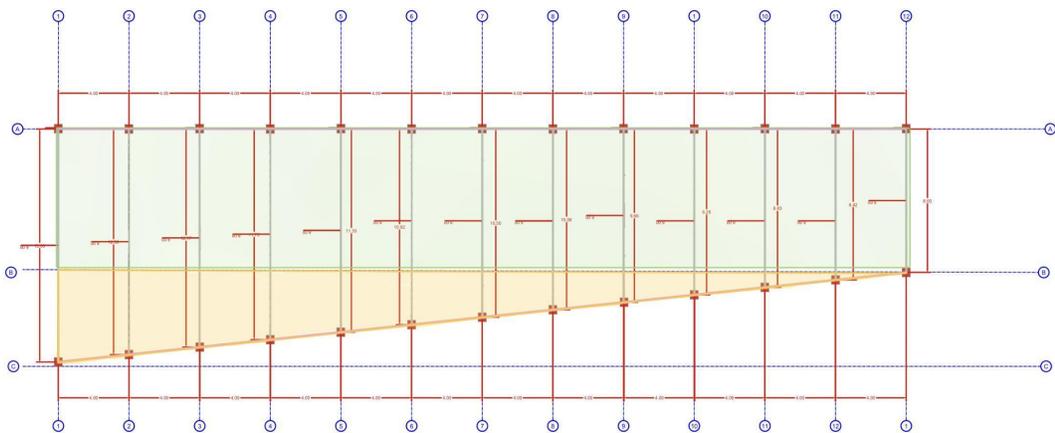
Plano vista superior del área de disposición actualmente implementada por la empresa (López, 2022).
